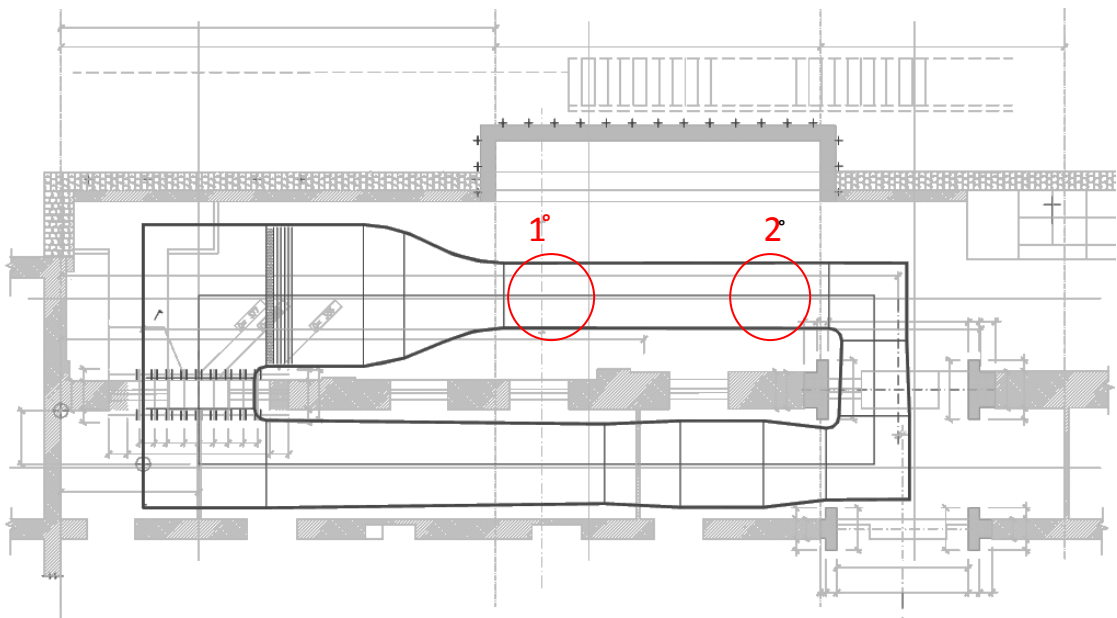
2: Planimetria dell'impianto e sua collocazione all'interno del laboratorio. Sono evidenziate le posizioni delle due sezioni di prova
